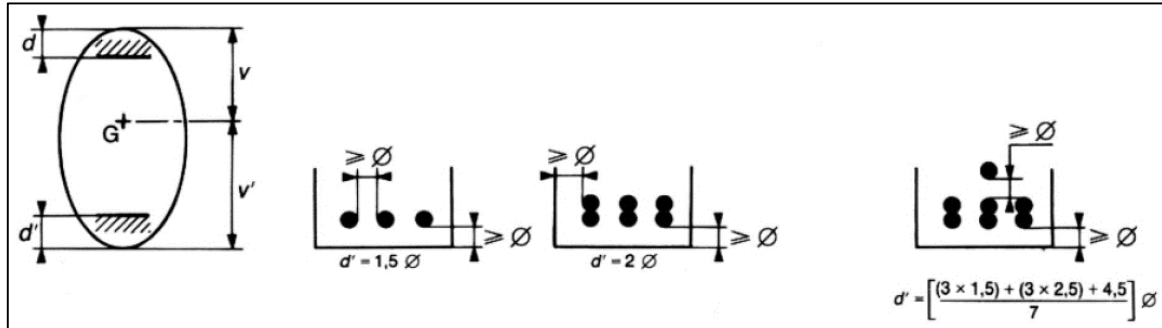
Dispositions constructives des câbles de précontrainte.
